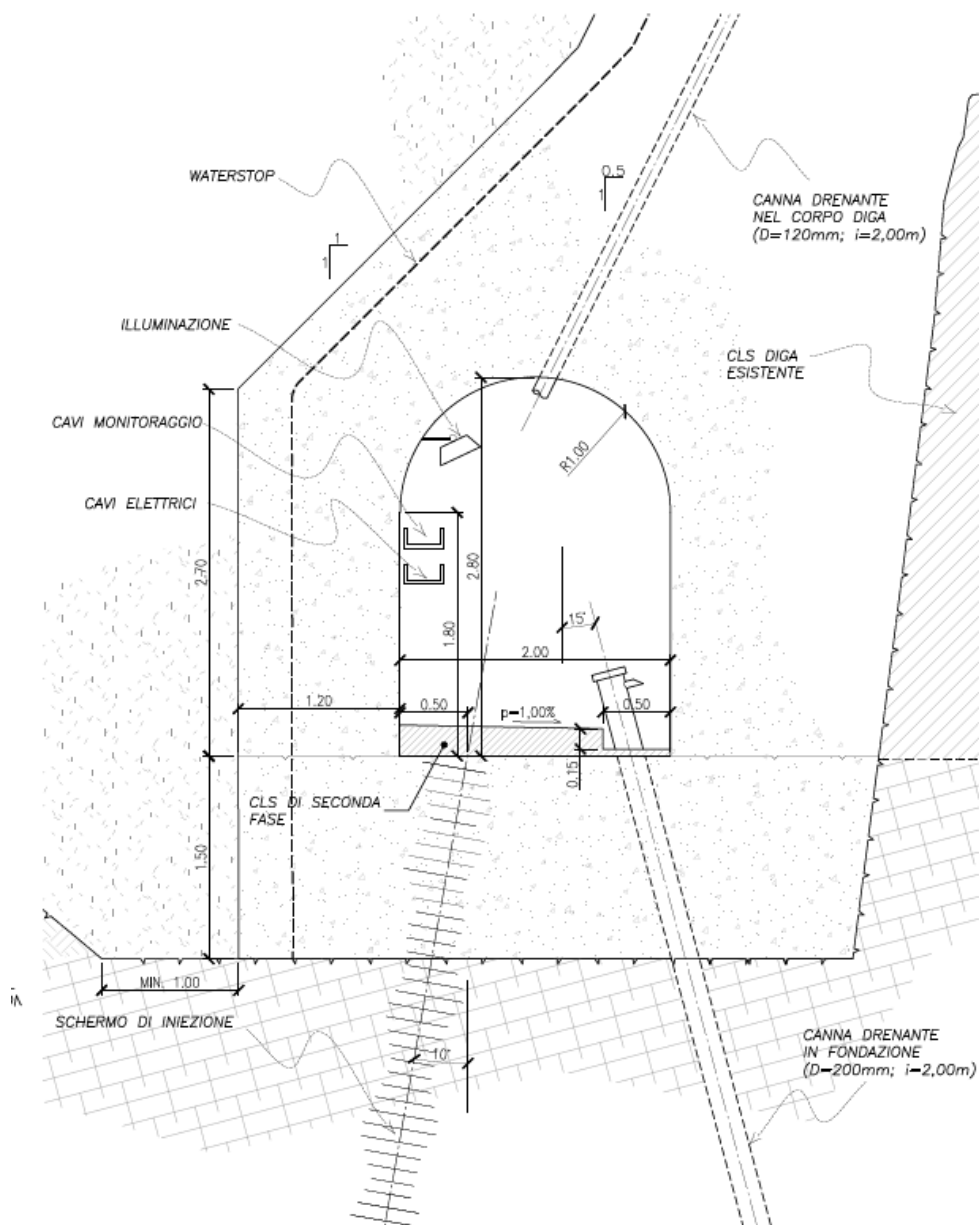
Nuovo piede di monte della diga con galleria d'ispezione e drenaggio longitudinale e schermo di iniezioni e drenaggio in fondazione
